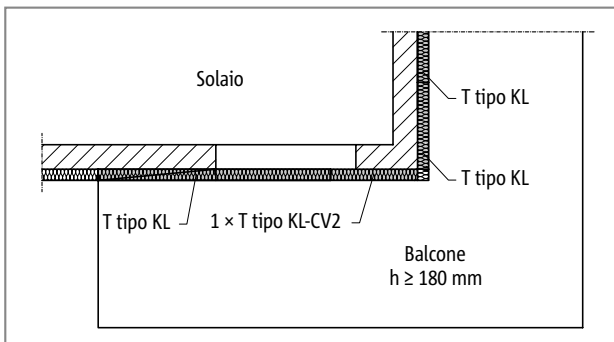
Schöck Isokorb® T tipo KL, balconi ad angolo esterno
